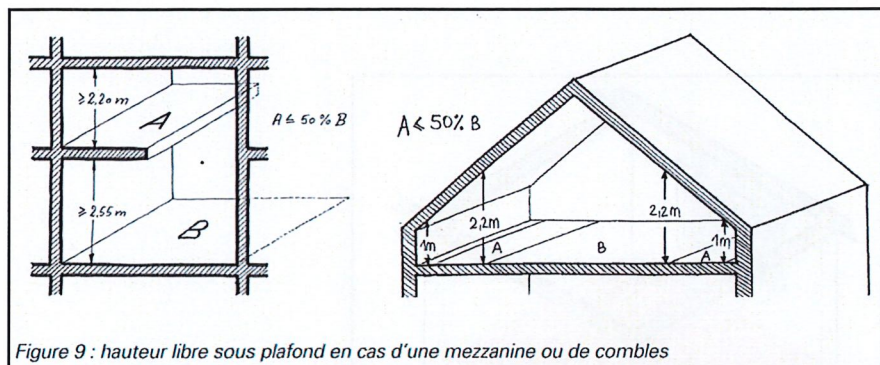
Hauteur libre sous plafond en cas d'une mezzanine ou de combles
